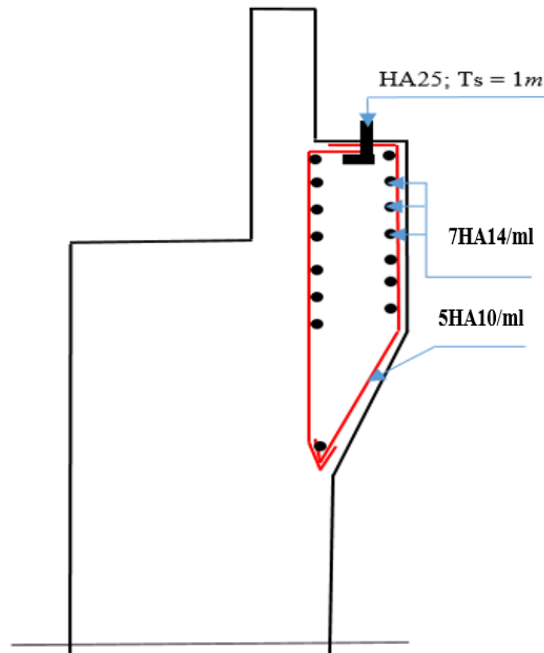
FERRAILLAGE DU CORBEAU
